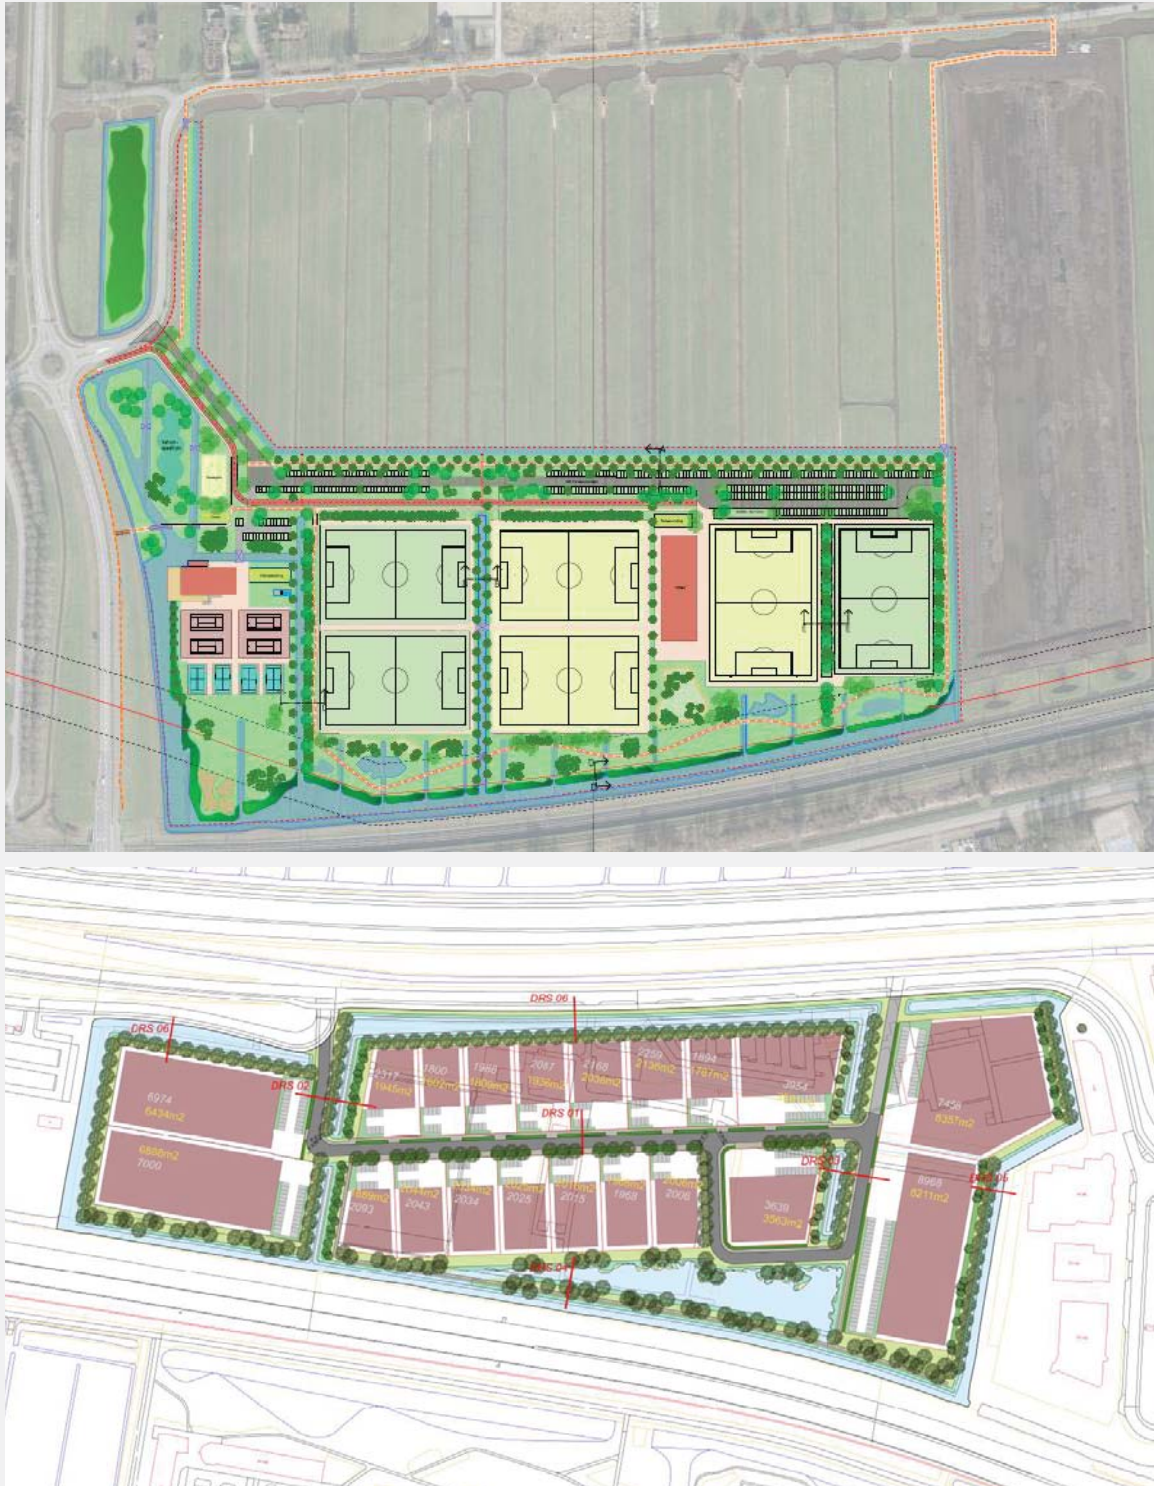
Locatie Sliedrecht Buiten [noordzijde spoor] en Stationspark III [huidig sportpark]
